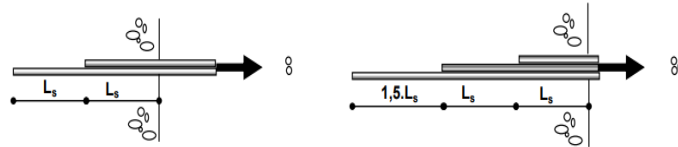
Disposition d'ancrage droit dans le cas de paquet de 2 ou 3 barres .
